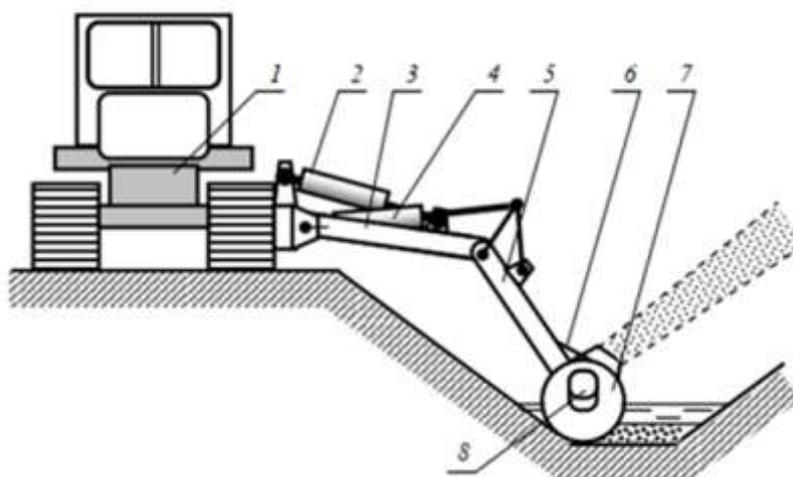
Схема работы каналоочистителя с фрезерным рабочим органом:
